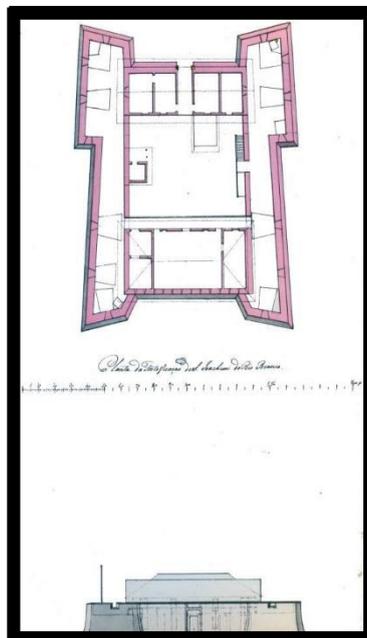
Planta do Forte São Joaquim, em Roraima, 1775.
